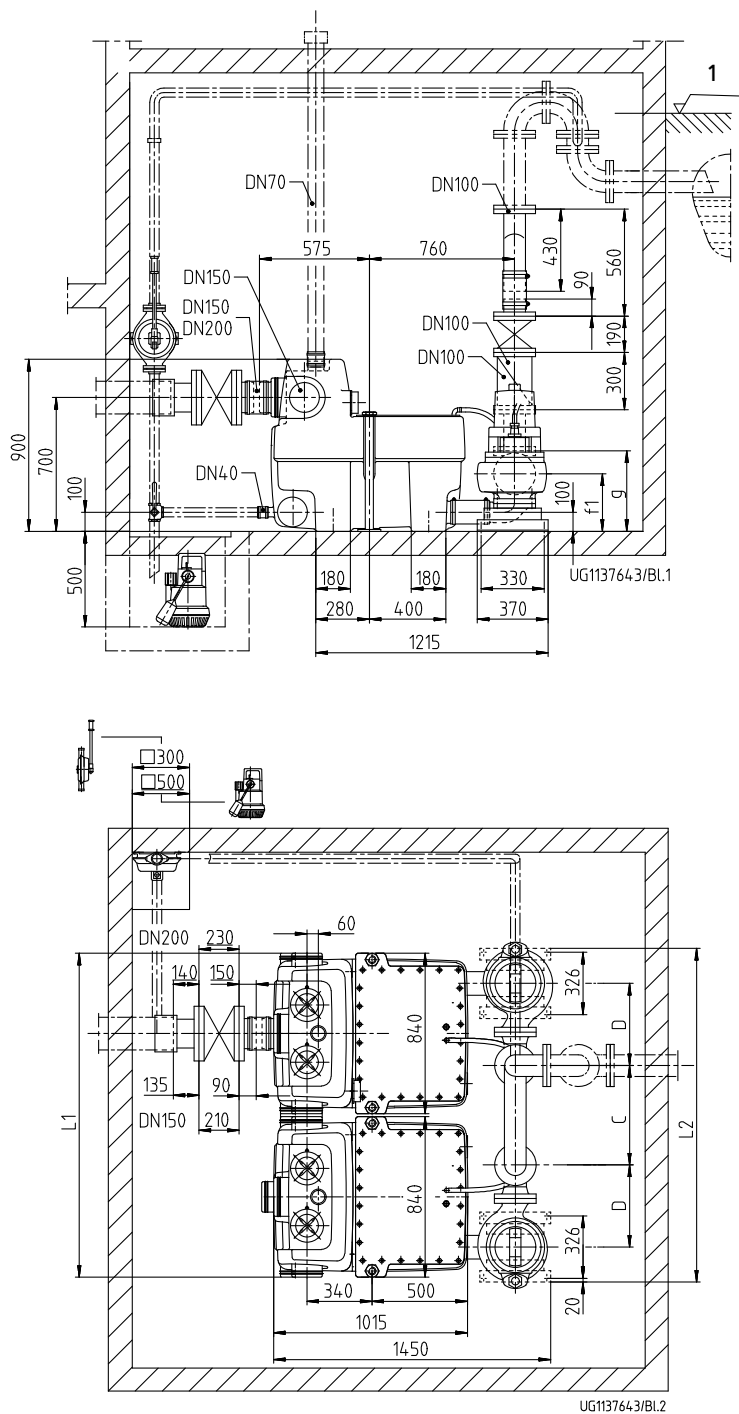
Установочные и присоединительные размеры Compacta UZ10.900 D - 15.900 D [мм]
